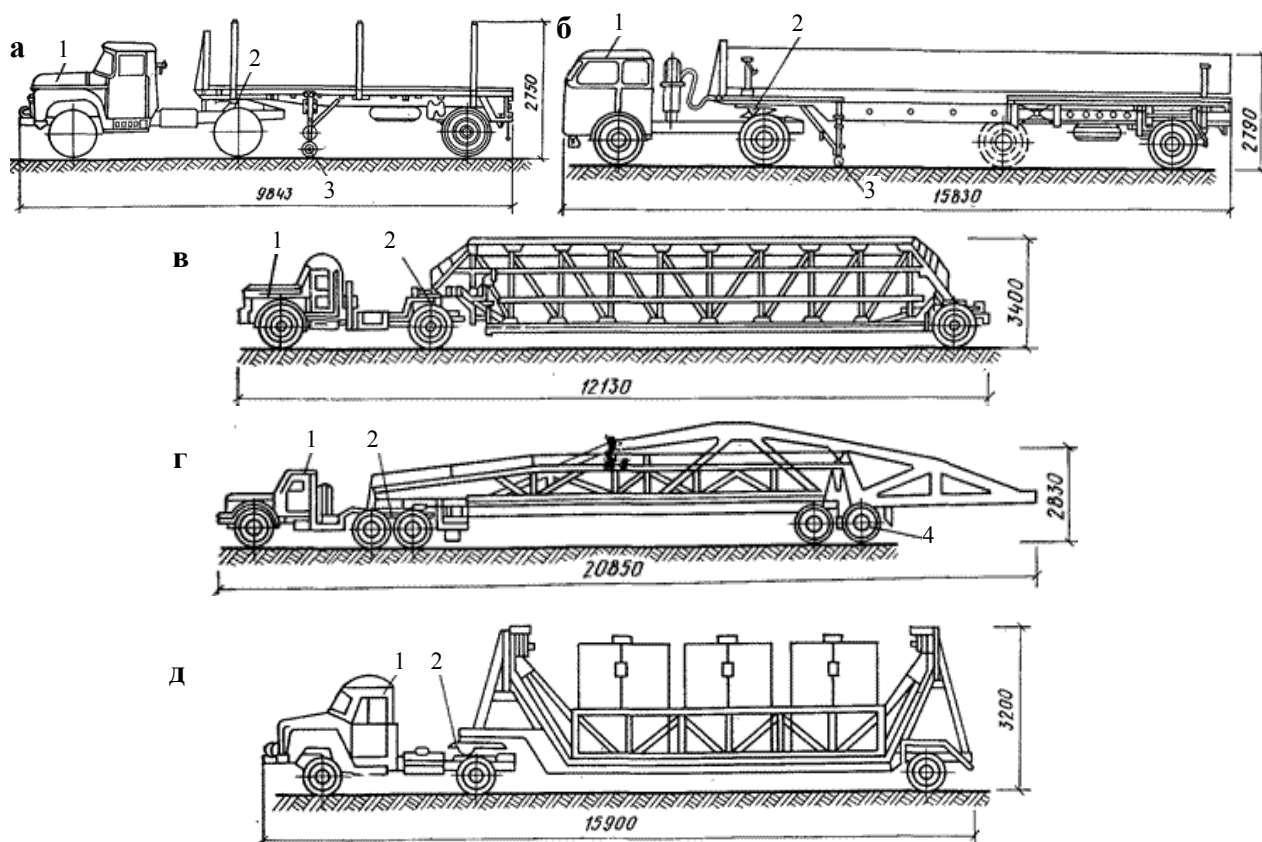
Спеціалізовані напівпричеми: а – плитовоз; б – розсувний балковоз; в – панелевоз; г – фермовоз; д – сантехкабіновоз; 1 – автомобіль-тягач; 2 – опорно-зчіпний пристрій; 3 – опорно-зупиночний пристрій; 4 – двовісна поворотна платформа
